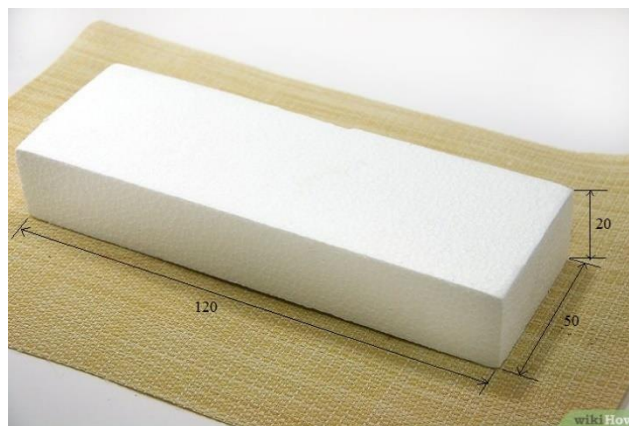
Образец пенополистирола марки ПСБ-С-25
